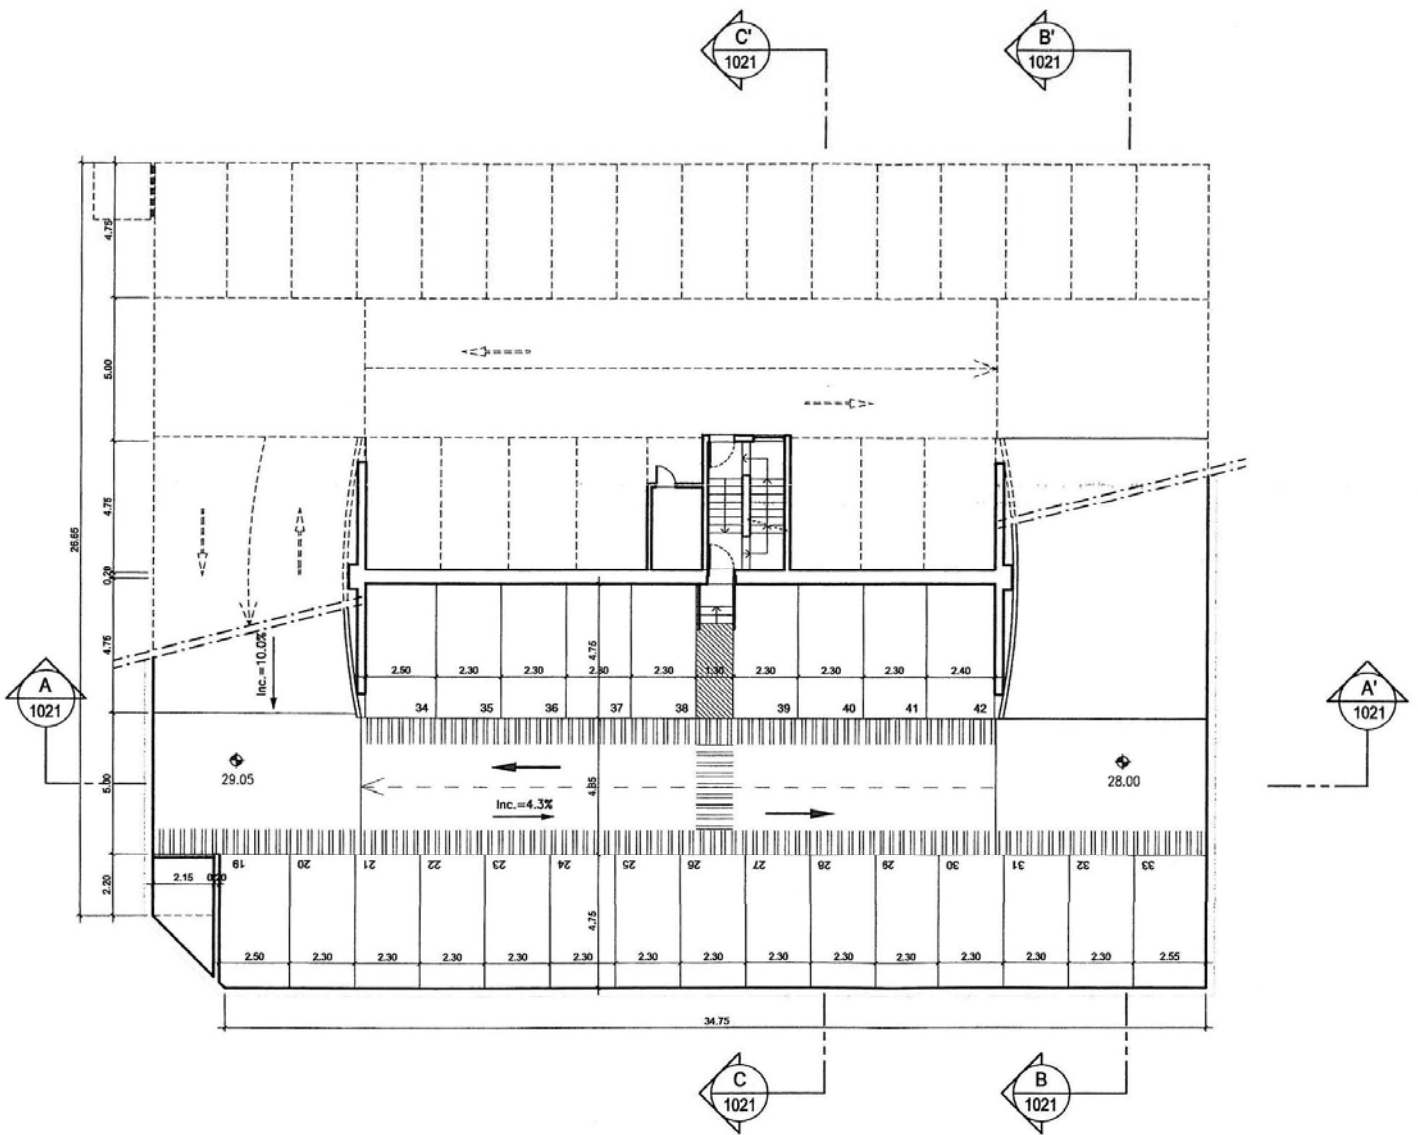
Tecnep, Planta Piso -1 superior – Processo de Obra CML, 2003
